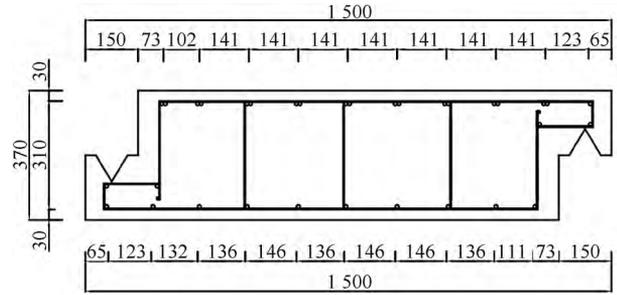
钢筋混凝土组合坝墙配筋(单位: mm)
